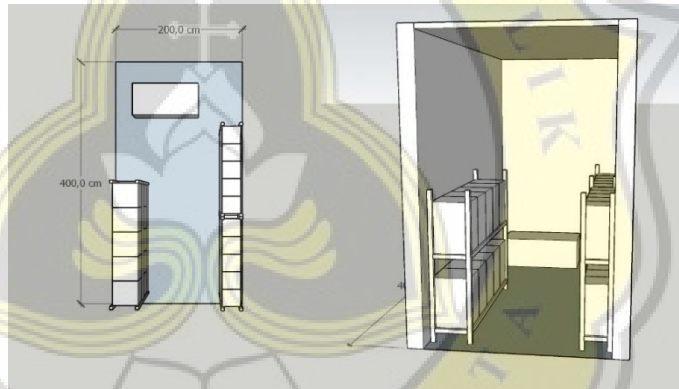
13 Layout Ruang Kios Burung Tipe B
